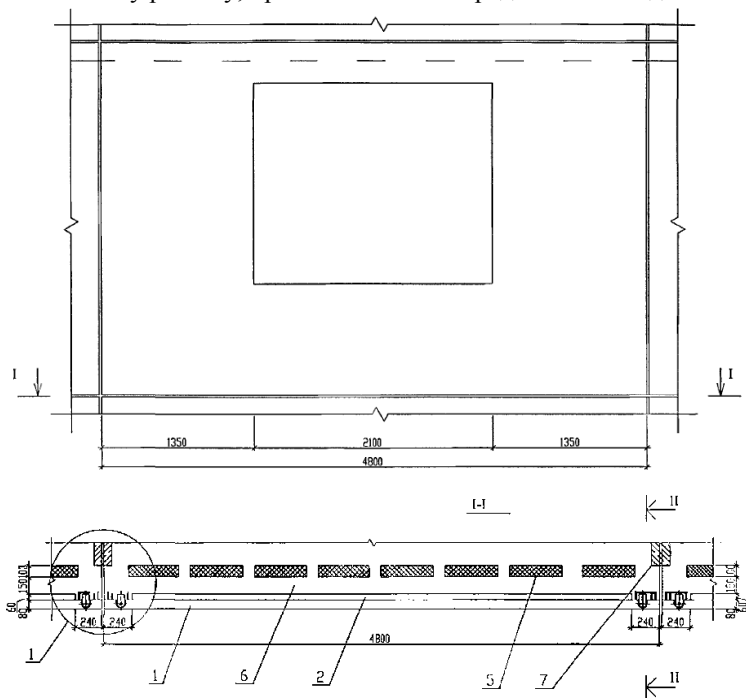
Устройство конструкций наружных стен с крупноразмерными экранами (1- экран, 2 - воздушный зазор, 4,5 - утеплитель, 6 - плита перекрытия, 7- внутренняя несущая стена)
